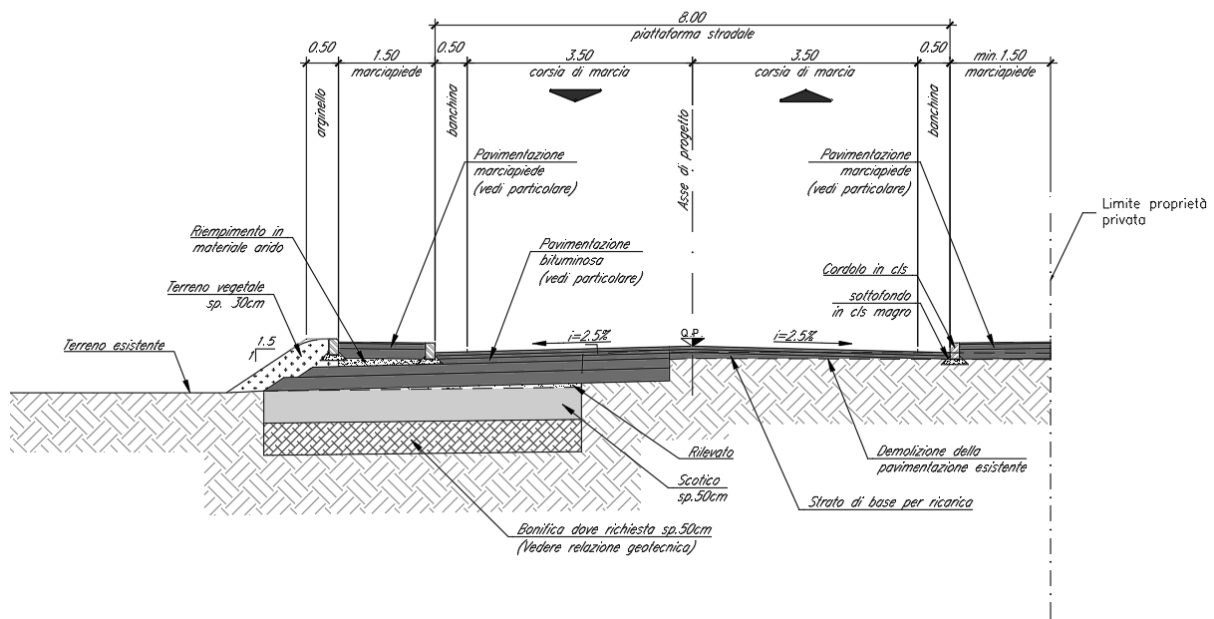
Sezione tipologica in rilevato NV16 Asse 1
